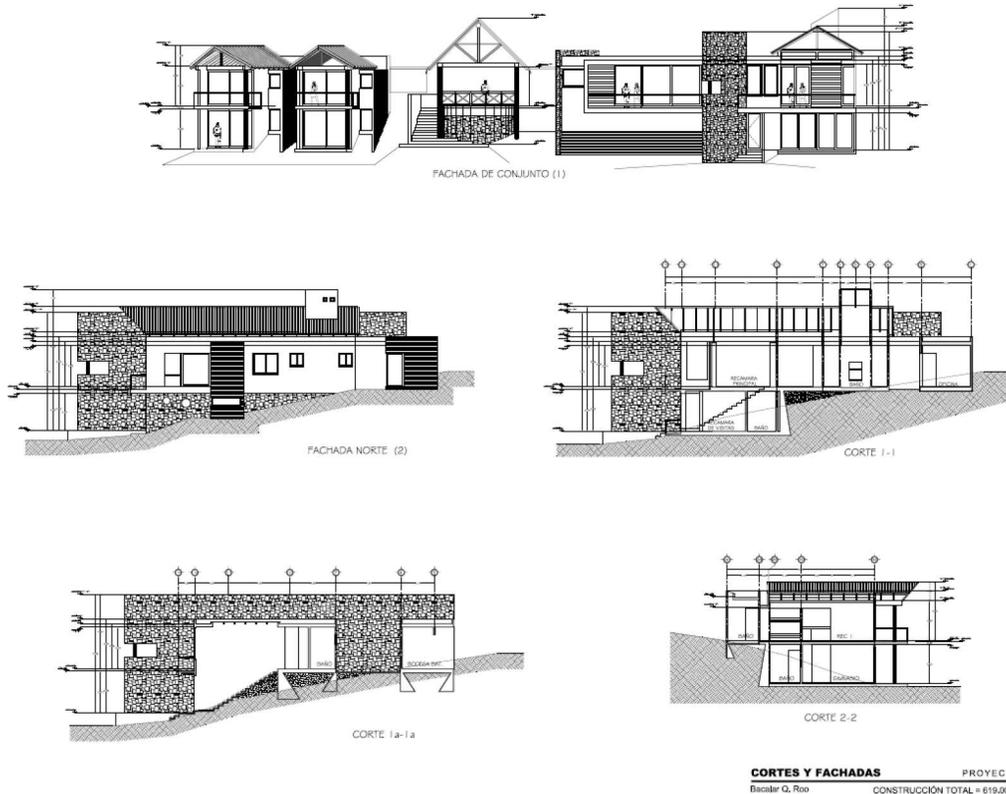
Plano corte y fachadas del proyecto CASA CAMINO AL VIENTO. la altura máxima es 9,70 metros
